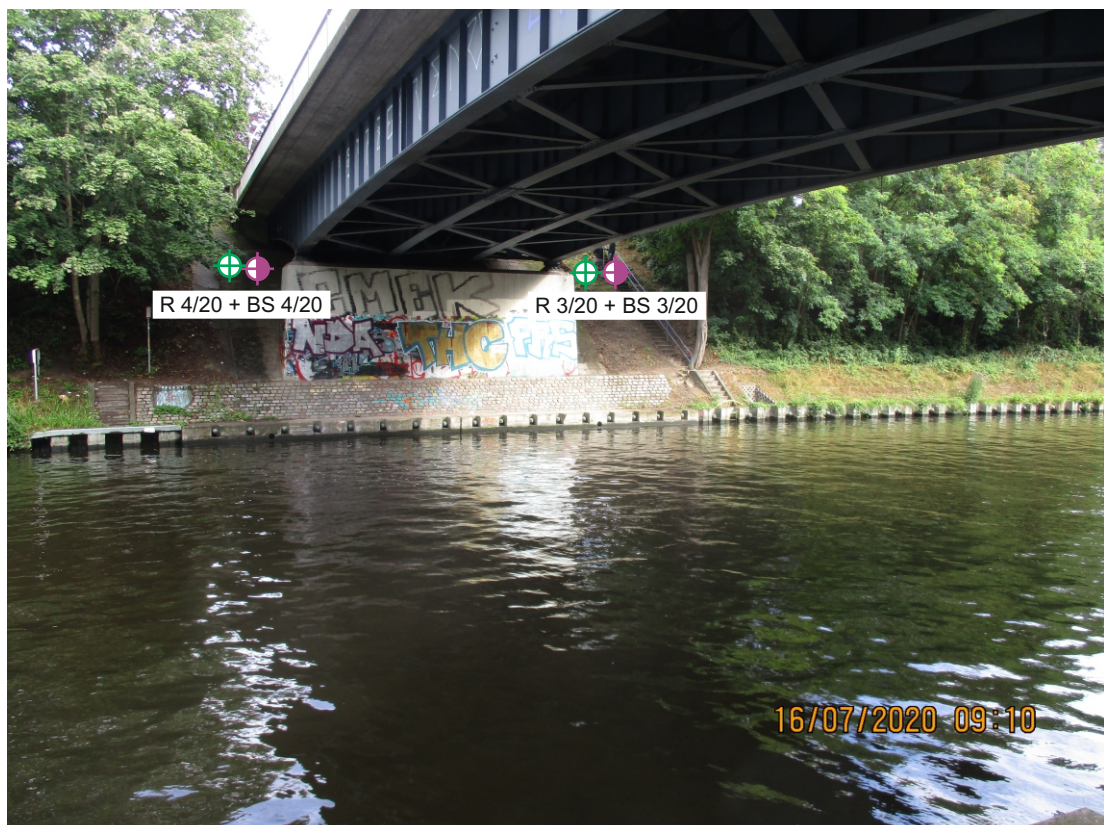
Nördl. Widerlager, Aufschlussansatzpunkte BS 3/20 + R 3/20 und BS 4/20 + R 4/20
